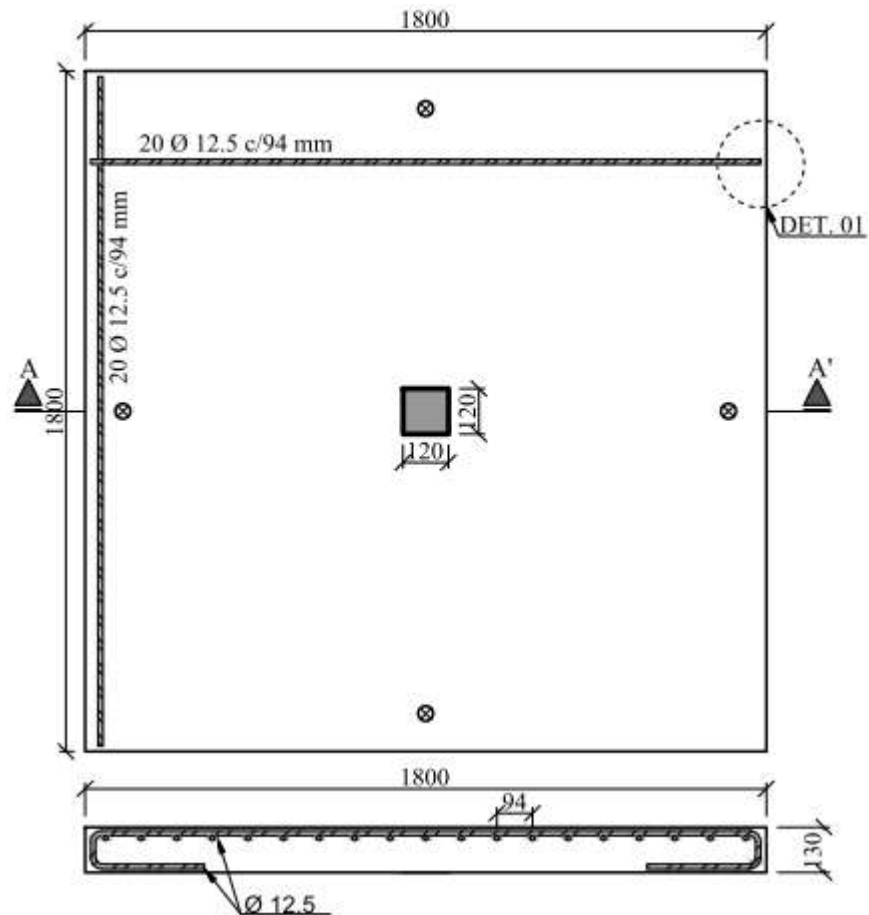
Disposição das armaduras de flexão (OLIVEIRA, 1998)
